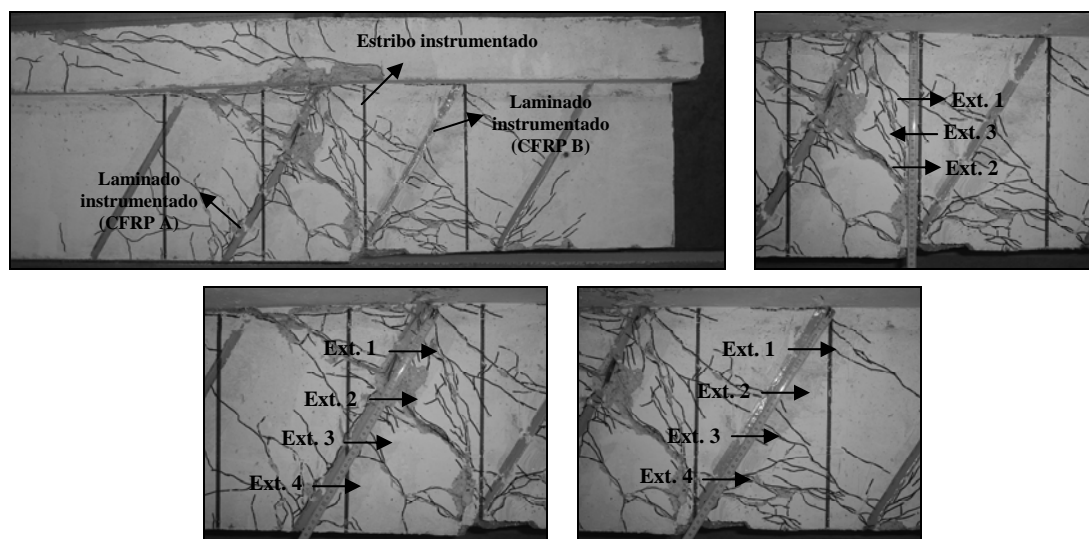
Localização dos extensómetros no laminado e estribo instrumentados da viga 4S-4LI60-C.
